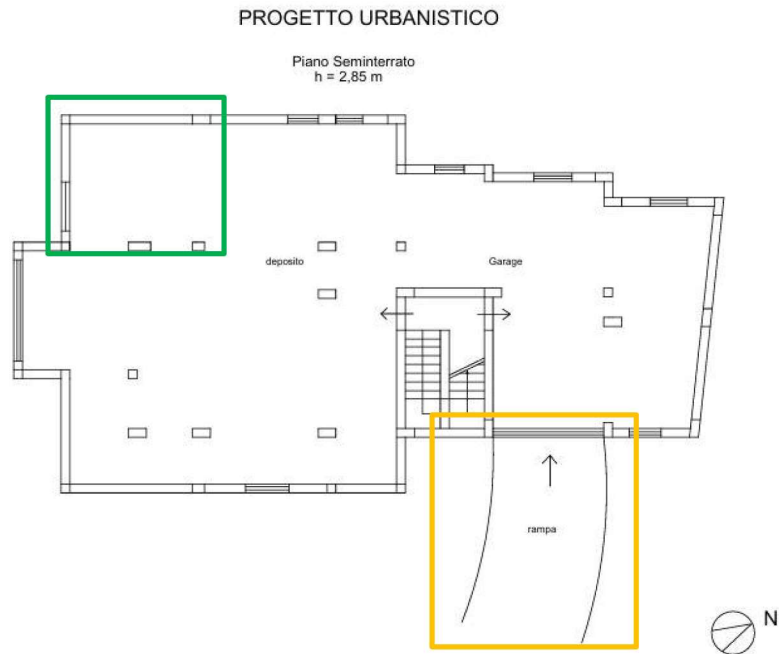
Planimetria Sub 5 e 6 unite di fatto Progetto Urbanistico Piano S1
